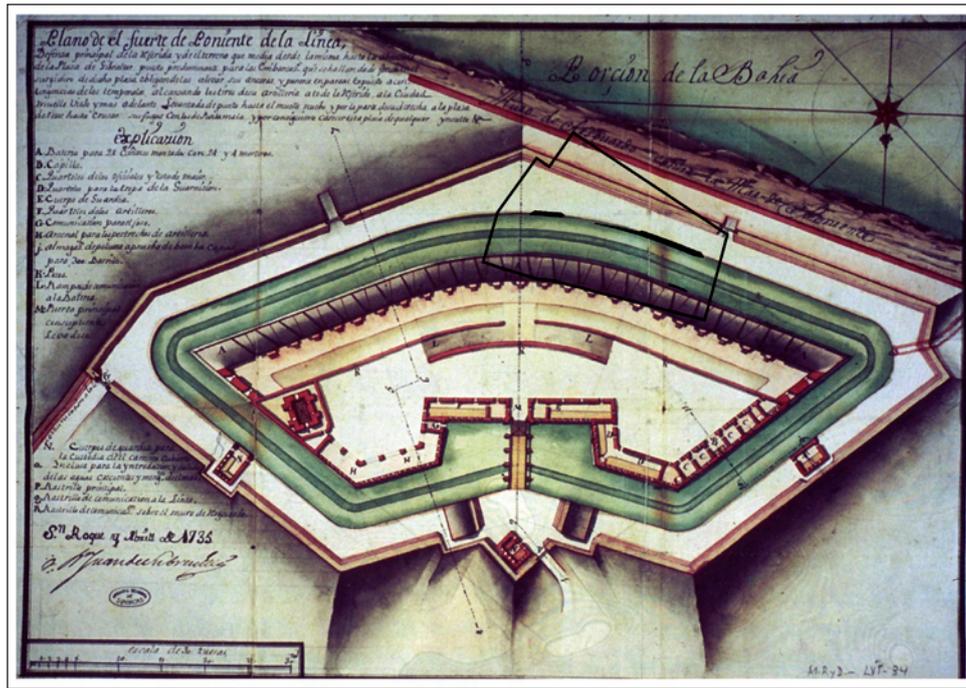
Superposición de los restos excavados sobre la planimetría del Fuerte de San Felipe (S. XVIII)
